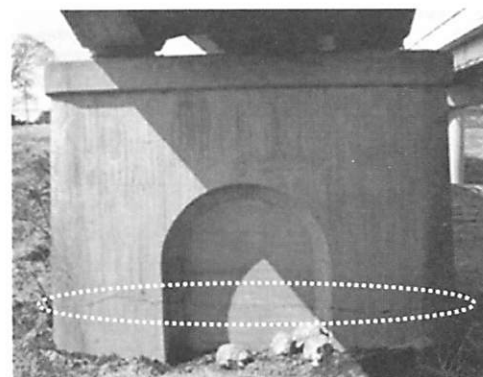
段落し部全周に発生した曲げひび割れ²⁾
